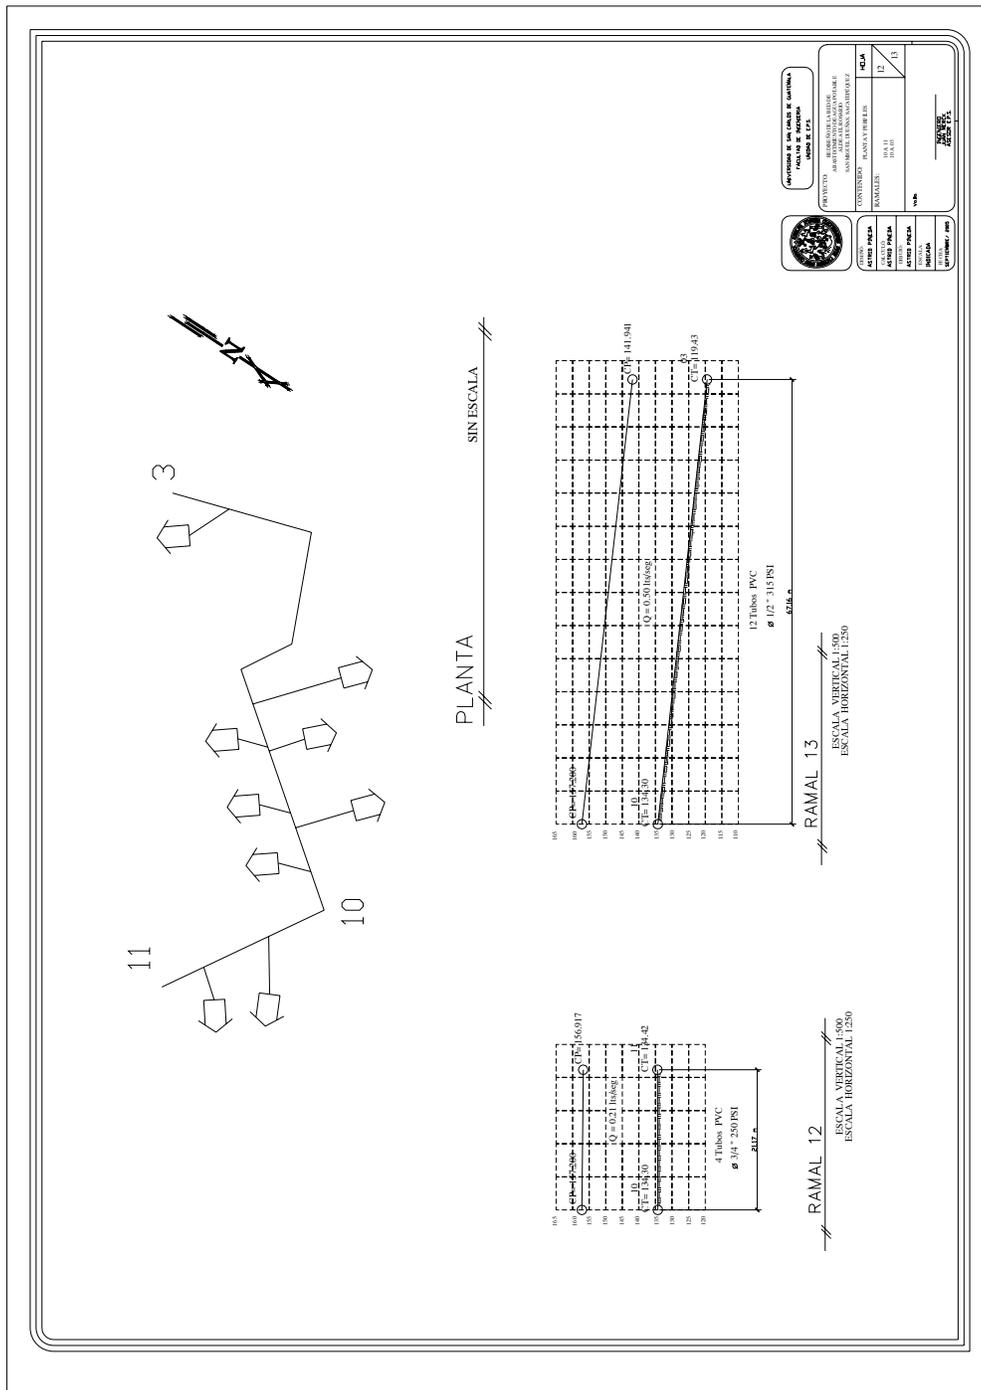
Planta y perfiles 03 a 06, 03 a 01, abastecimiento de agua potable
